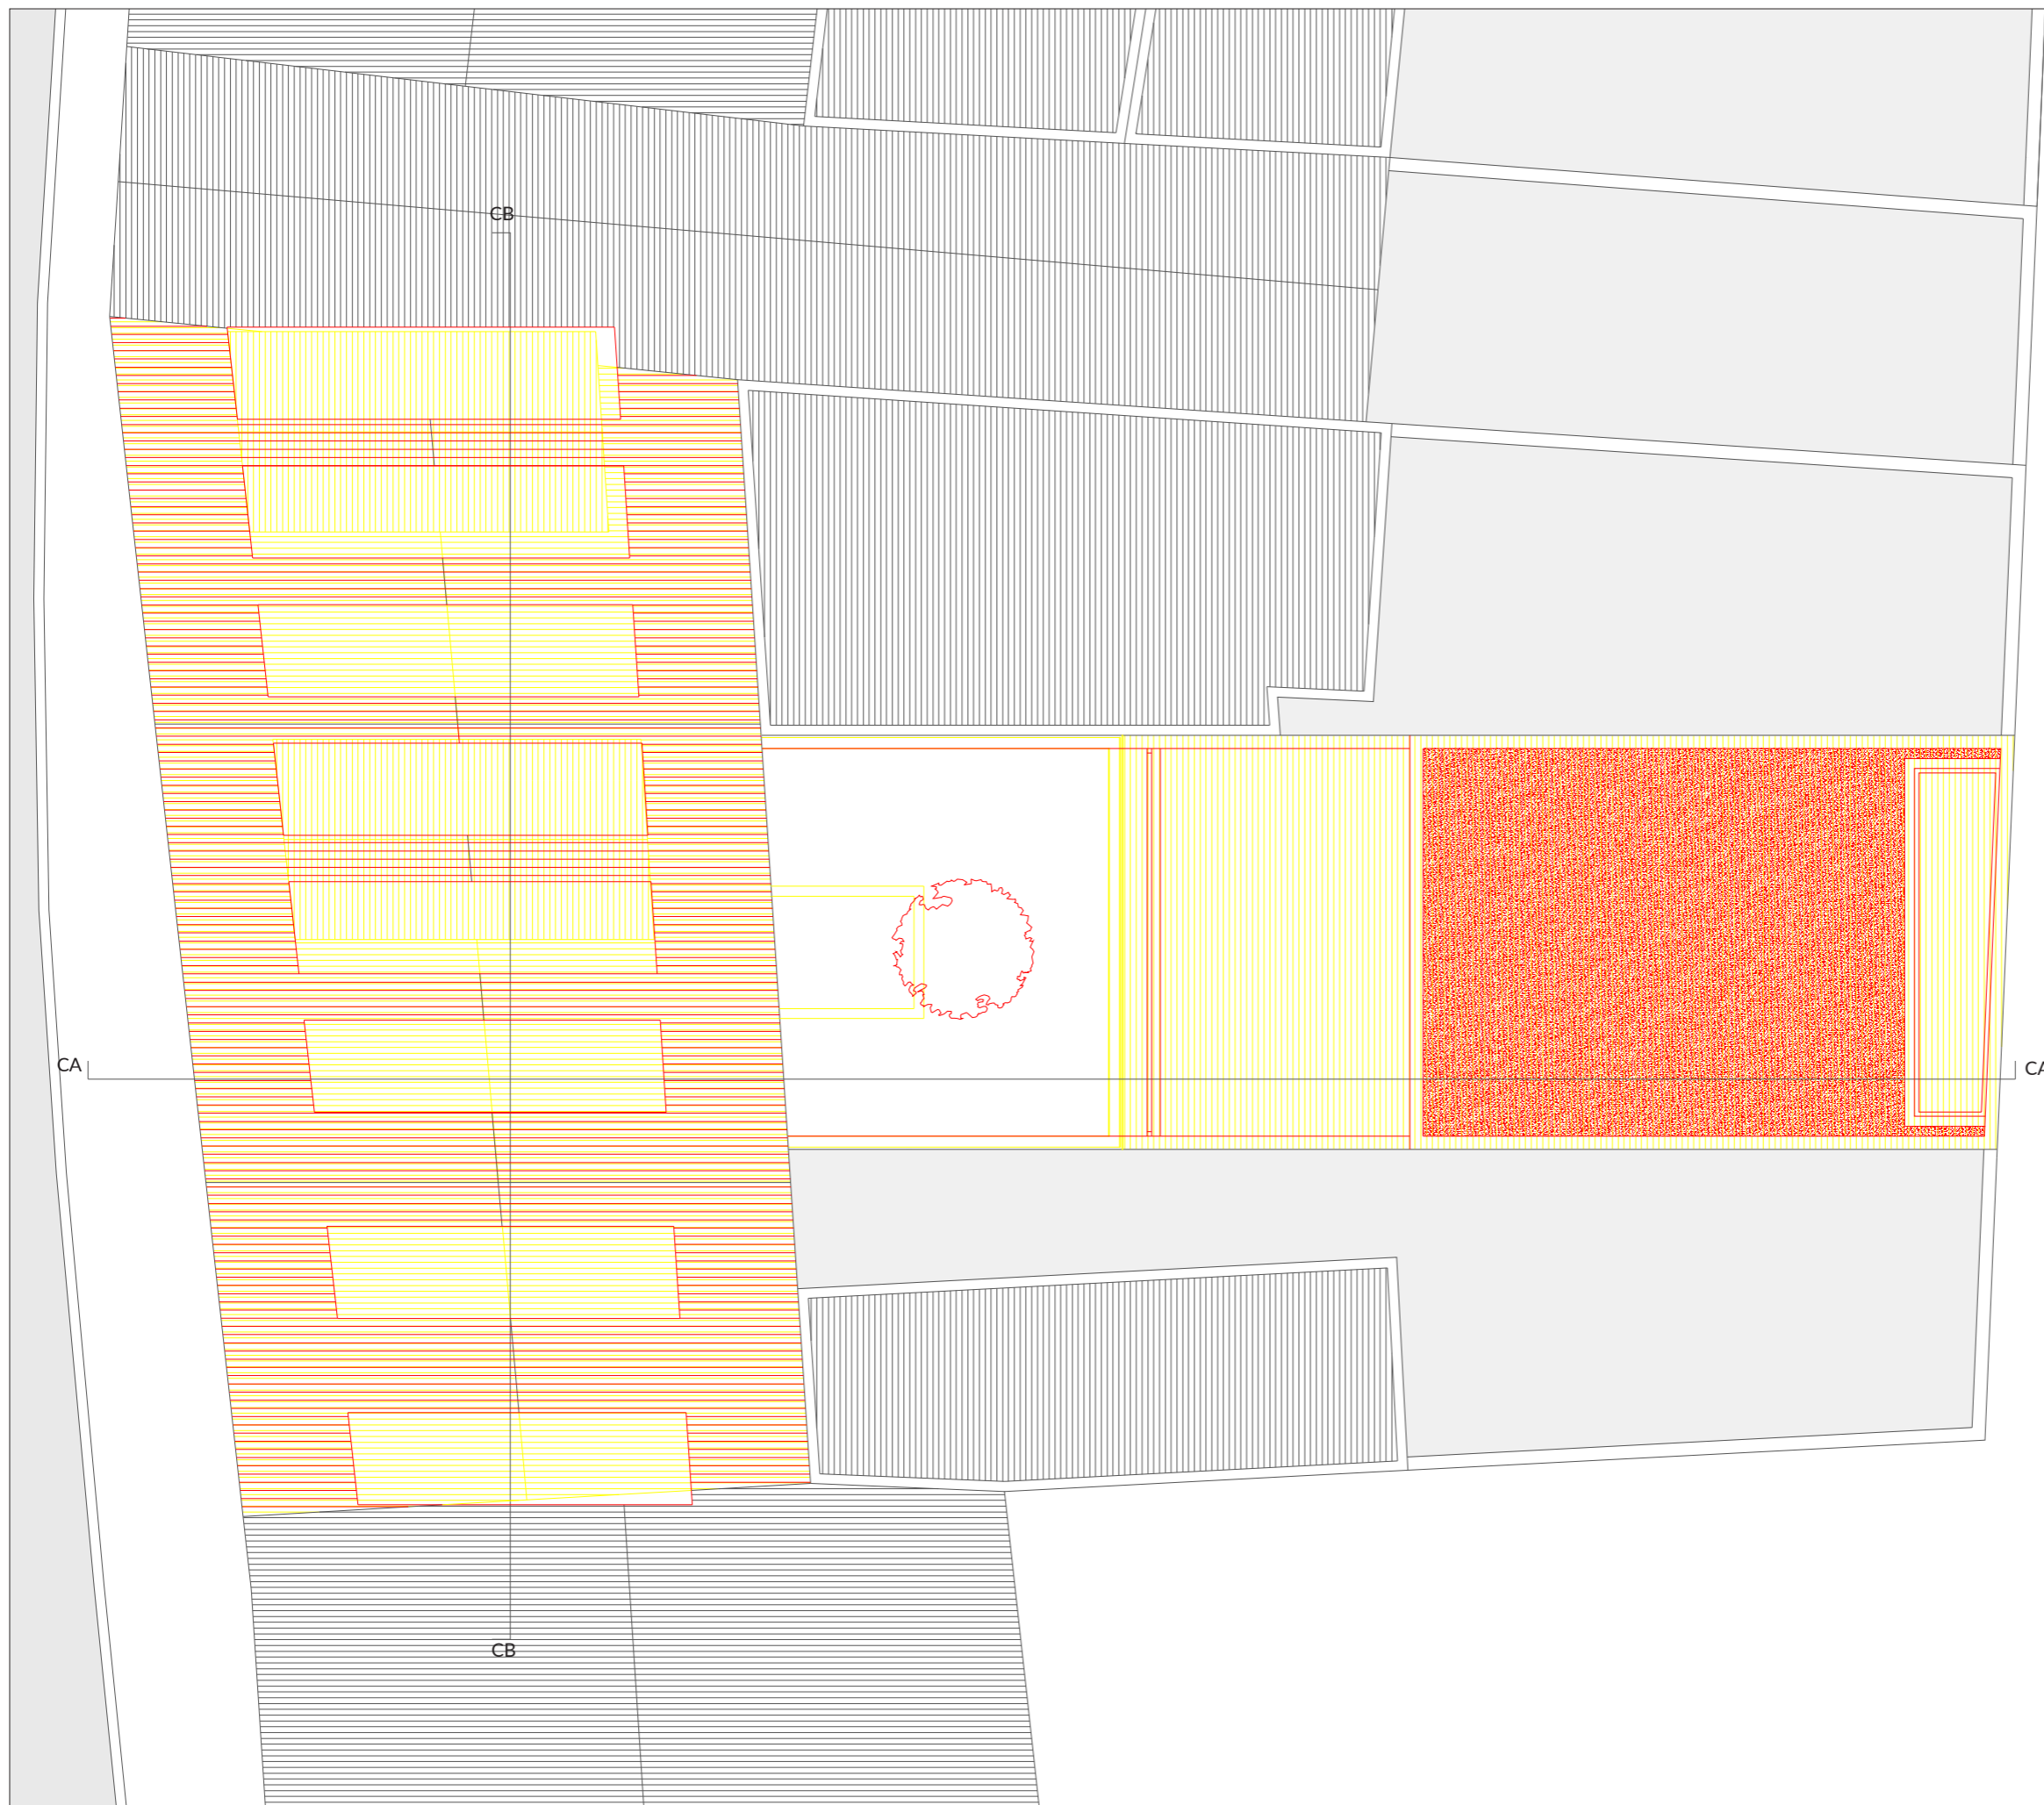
Planta do piso 3 | Vermelhos e amarelos
